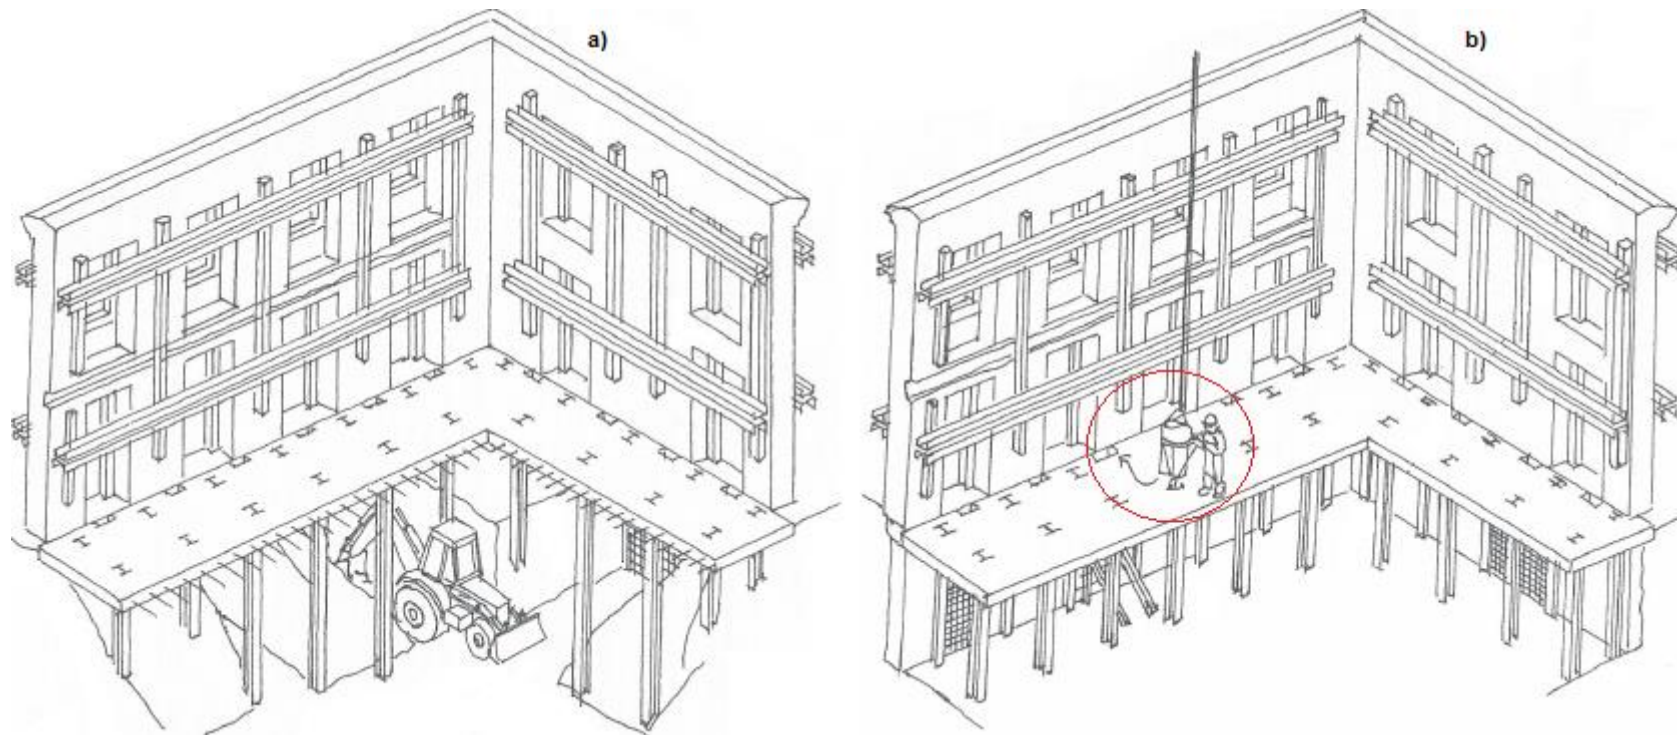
Construção da cave: a) escavação do primeiro nível; b) construção dos painéis das paredes [55]
